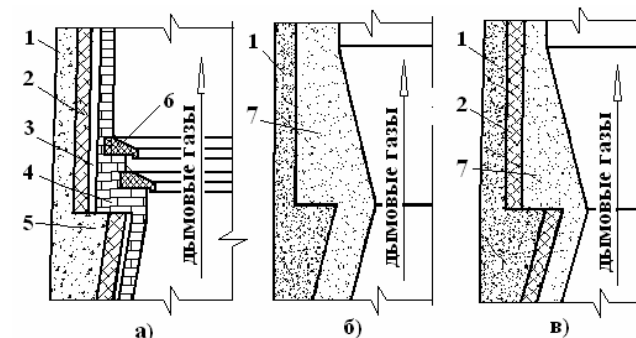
Схема вертикального сечения дымовой трубы ИвТЭЦ-1: а – существующая конструкция; б – с прижимной монолитной футеровкой; в – с монолитной футеровкой и теплоизоляцией; 1 – несущая железобетонная оболочка; 2 – теплоизоляция; 3 – воздушный зазор; 4 – кирпичная футеровка; 5 – консоль; 6 – слезниковый кирпич; 7 – монолитная футеровка
